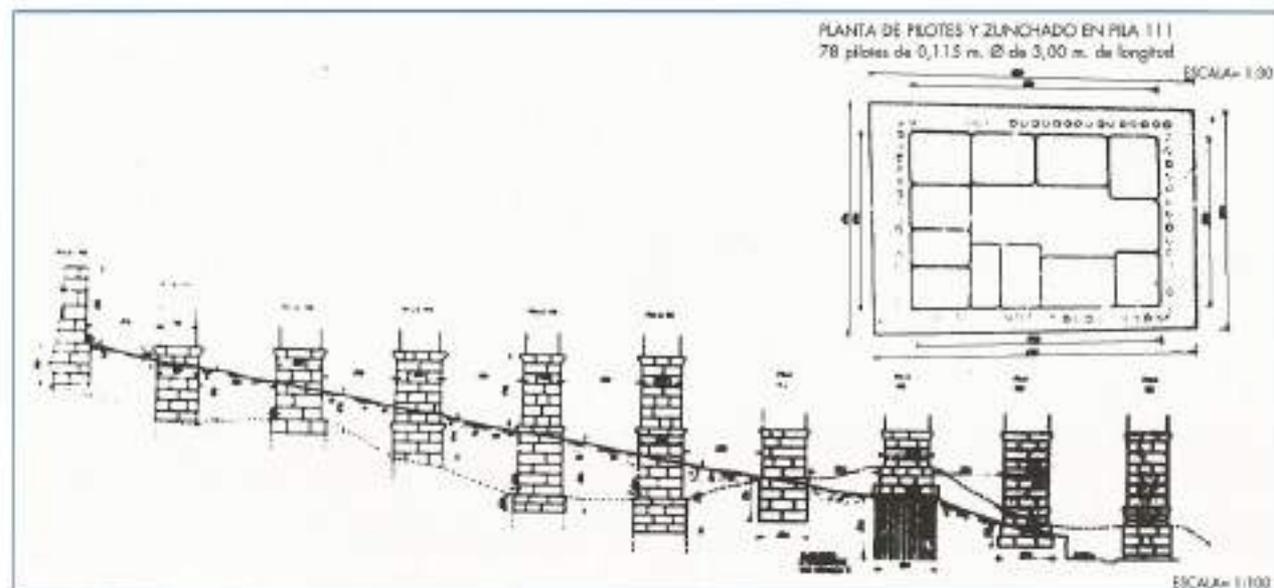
Pila consolidada con pilotes y perfiles del terreno.
